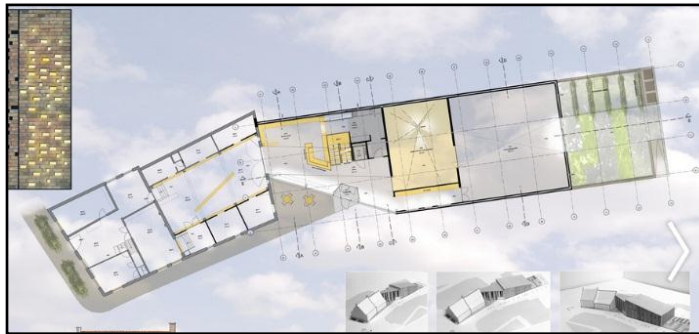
Plan du RDC. Source : <https://www.archdaily.com/443783/restoration>
